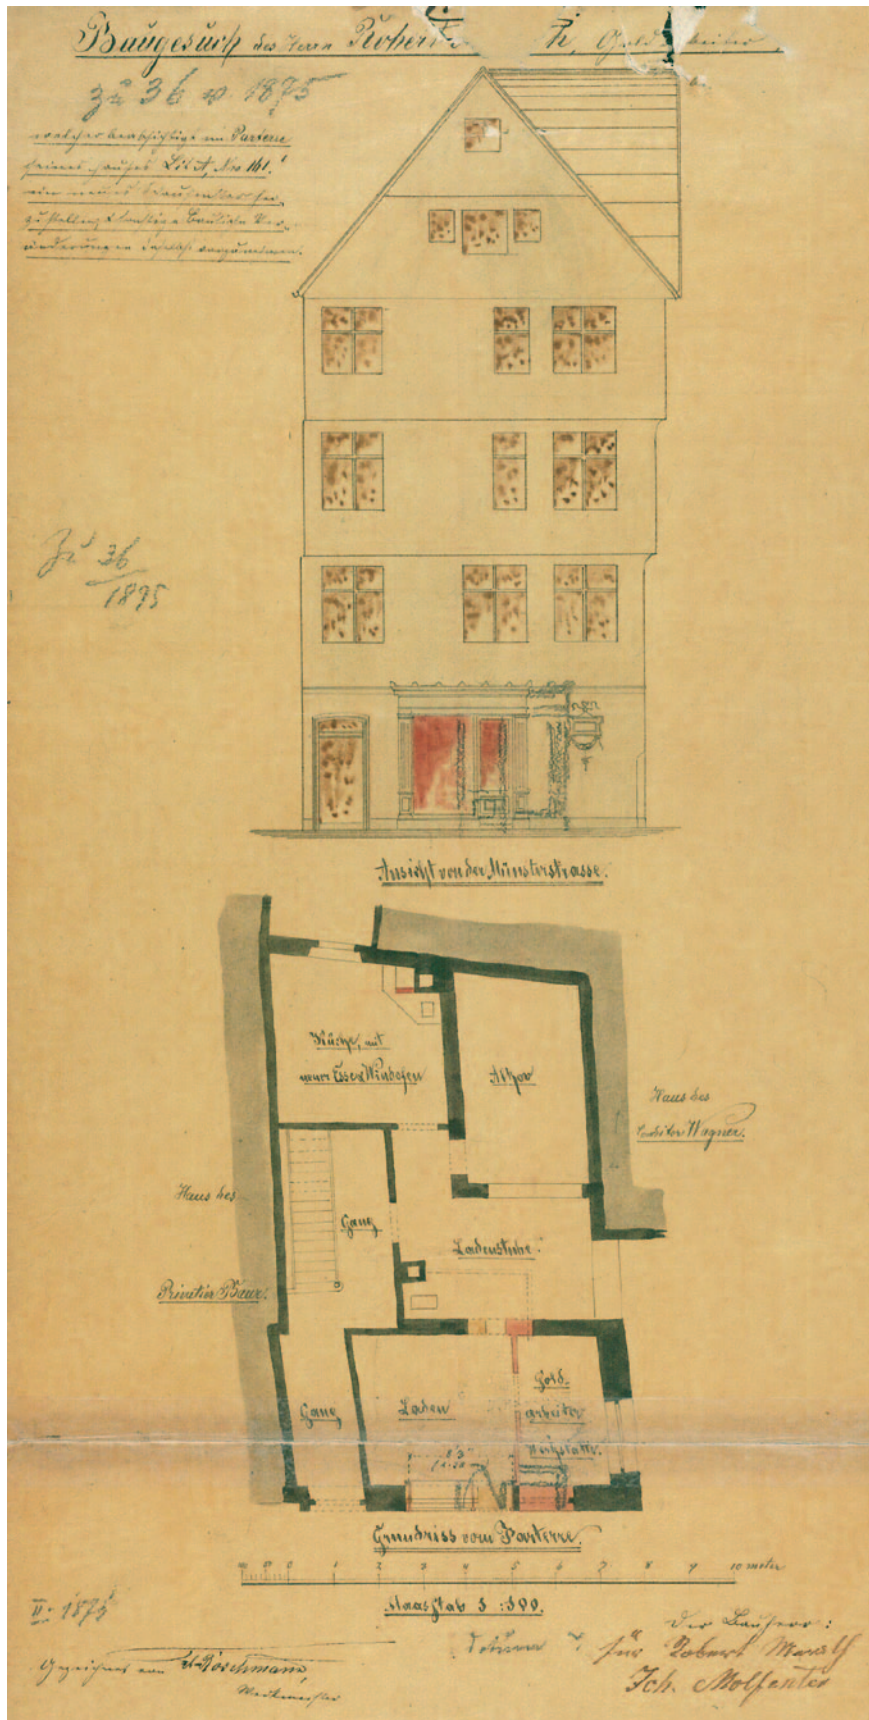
Gebäude Sattlergasse 13 (A 161/1), Westansicht und Grundriss des Erdgeschosses, Baugesuch 1875.
